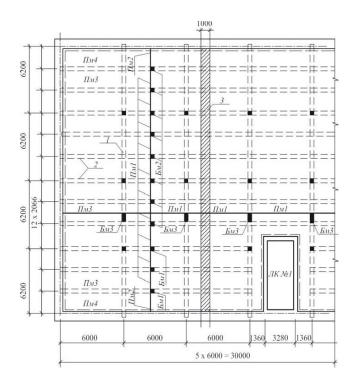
Конструктивная схема монолитного перекрытия: 1 — главные балки; 2 — второстепенные балки; 3 — условная полоса шири ной 1 м для расчета плиты
